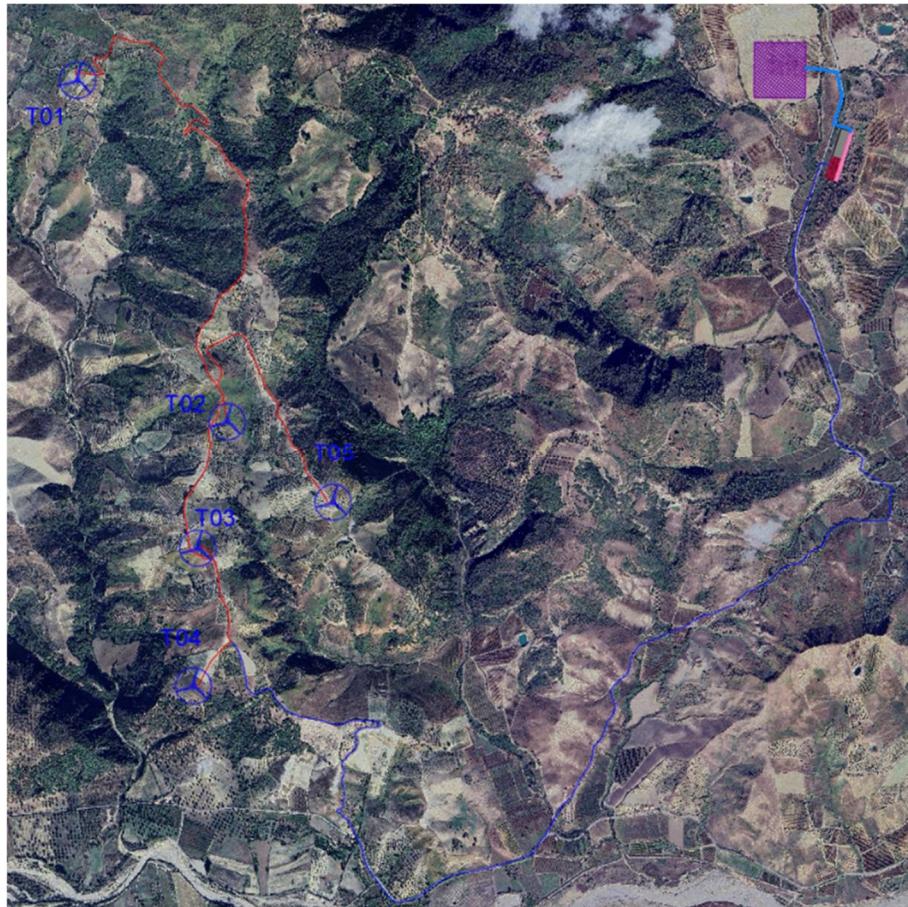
/B - Layout impianto alternativa “due”
